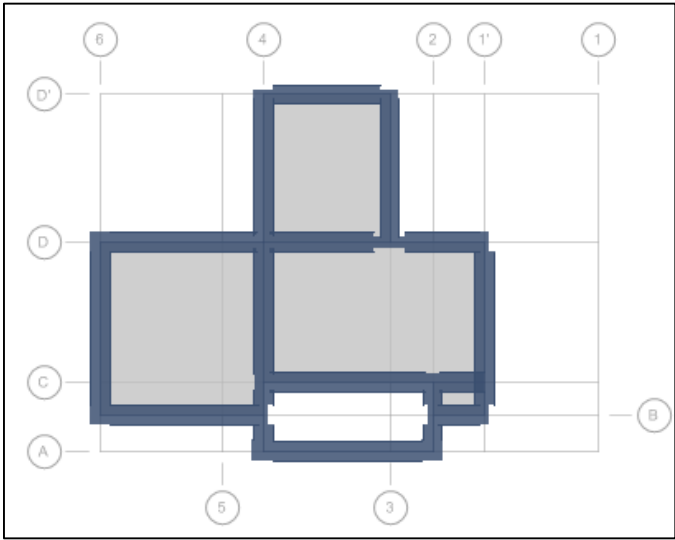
Planta N+11.68 Estructura 3.2 Torre Occidental
